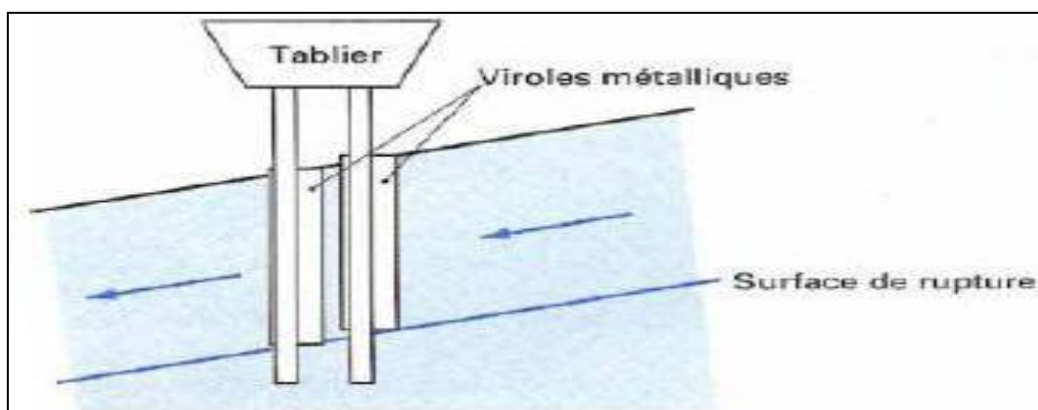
Principe d'un dispositif de fondation sur pieux dans un glissement
